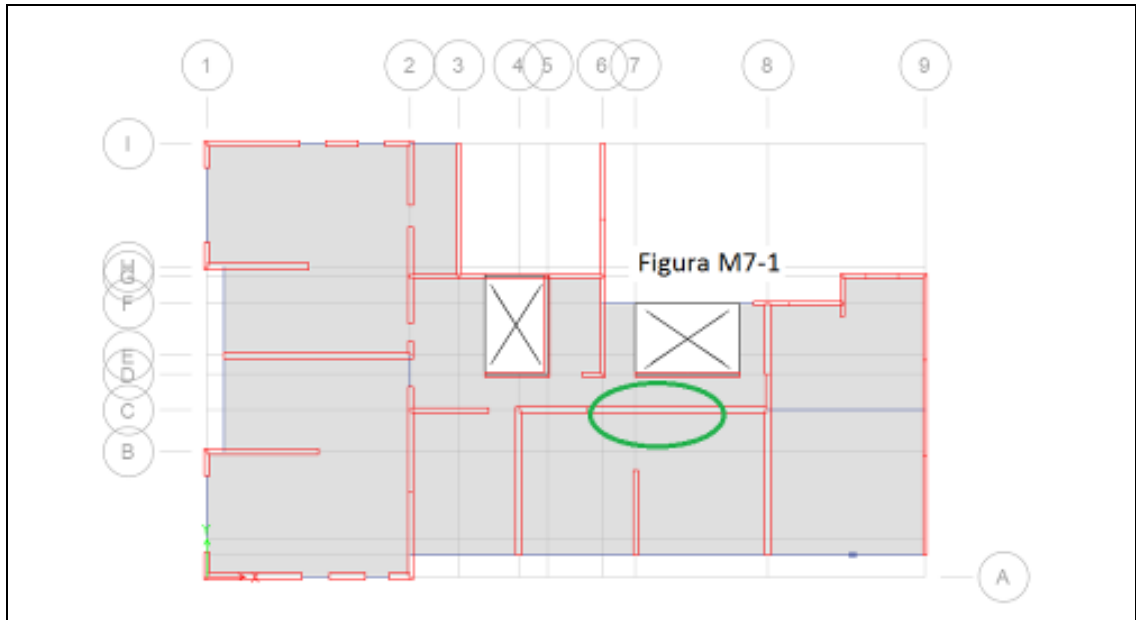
Edificio M7, planta piso 1, se indican los elementos dañados
